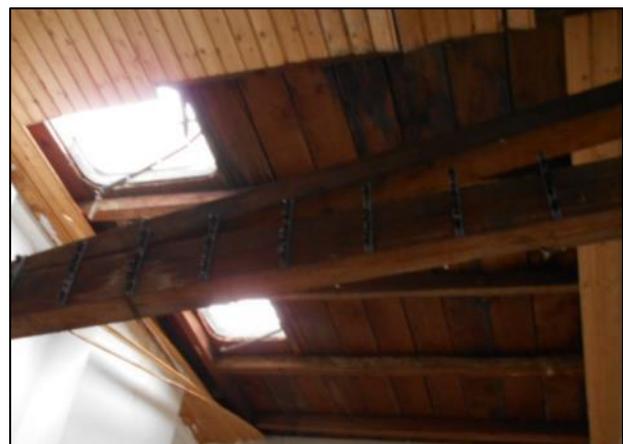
Spaltenpotential durch fehlende Holzverkleidung im Dachbereich
